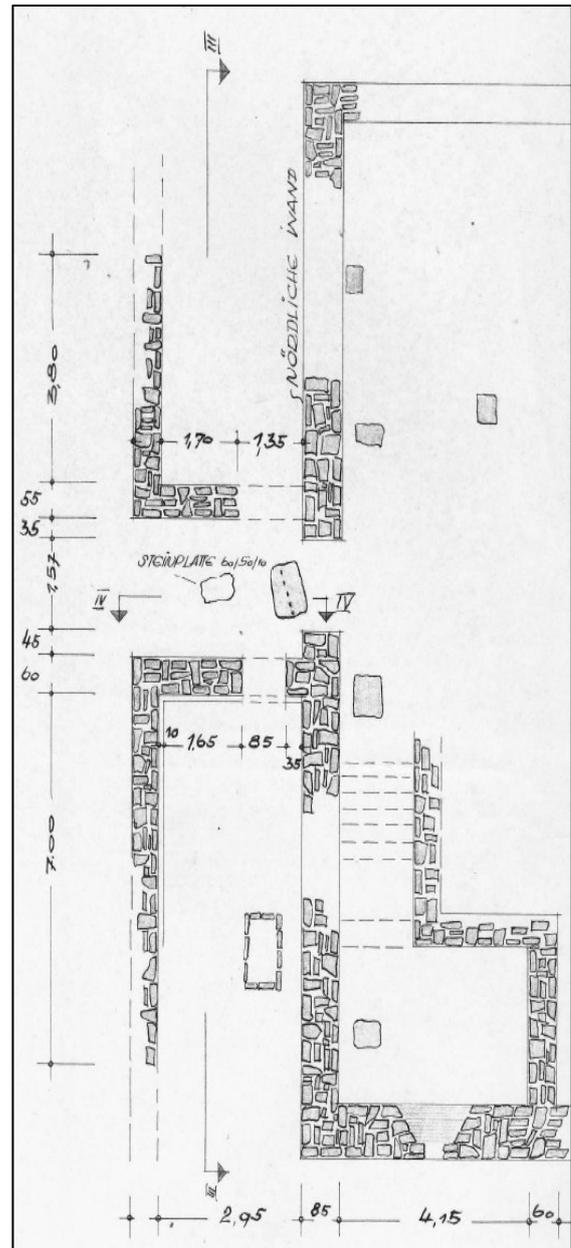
Plan des nördlichen Bereichs der Villa. M 1:100.
